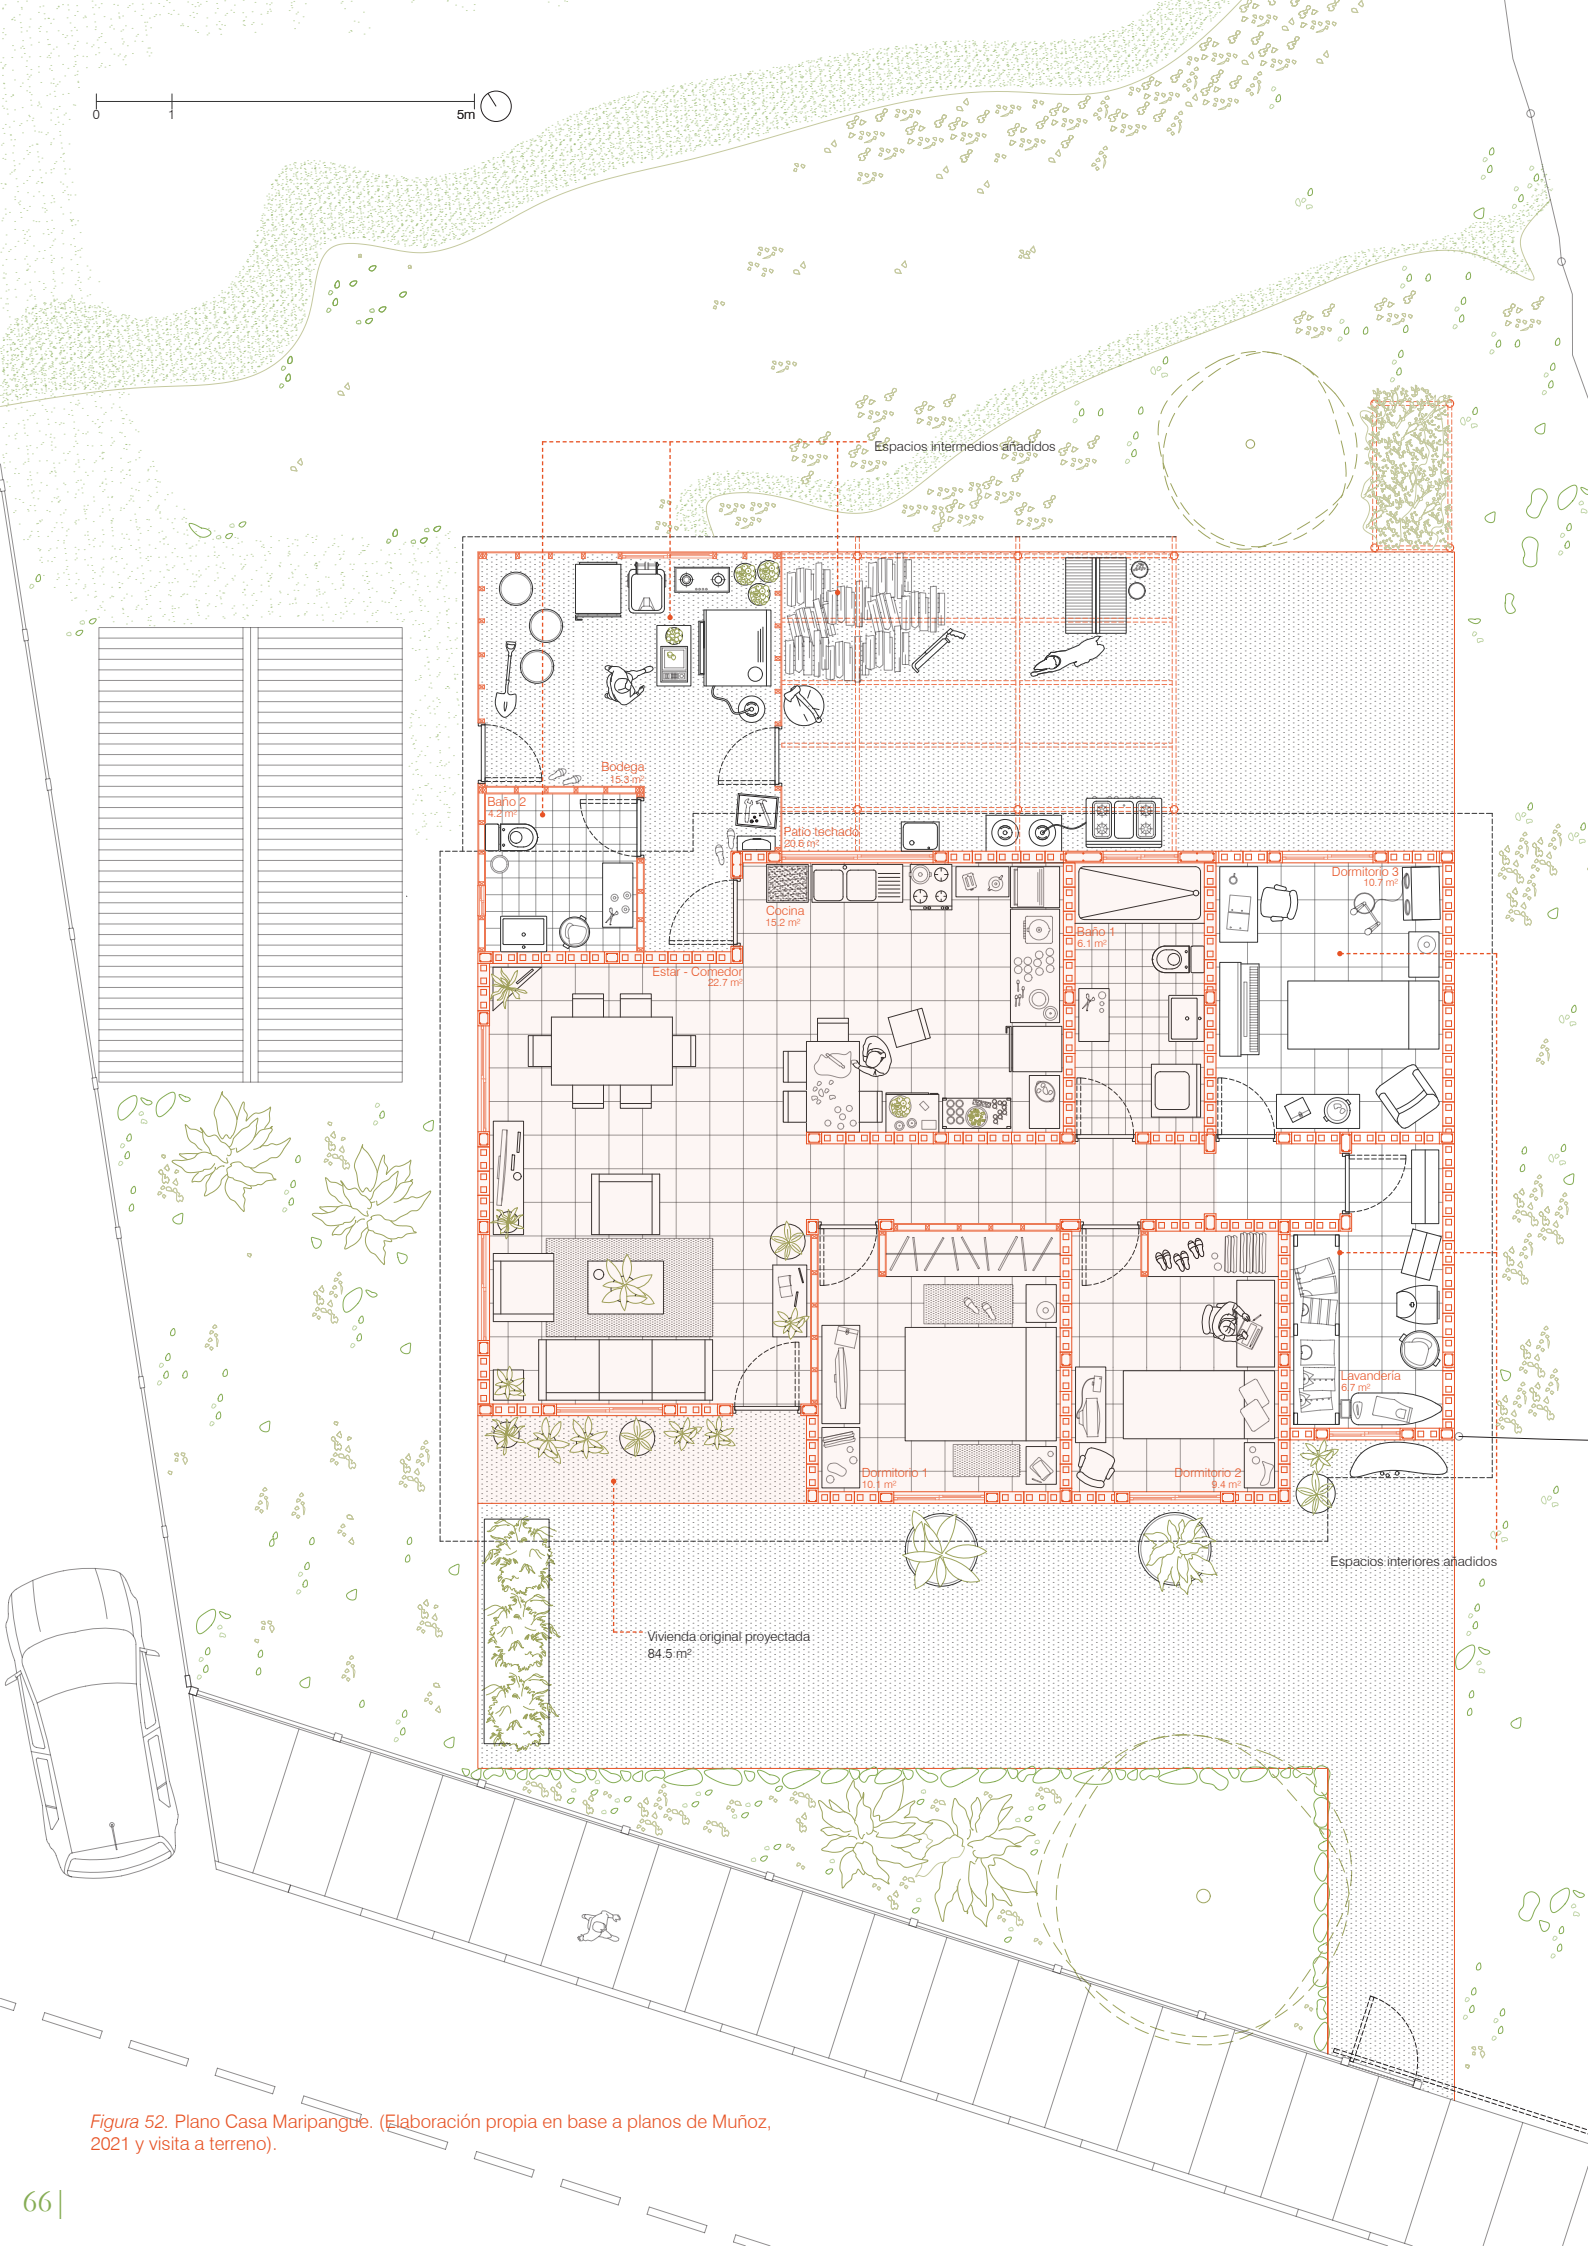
Plano Casa Maripangue. (Elaboración propia en base a planos de Muñoz, 2021 y visita a terreno).
